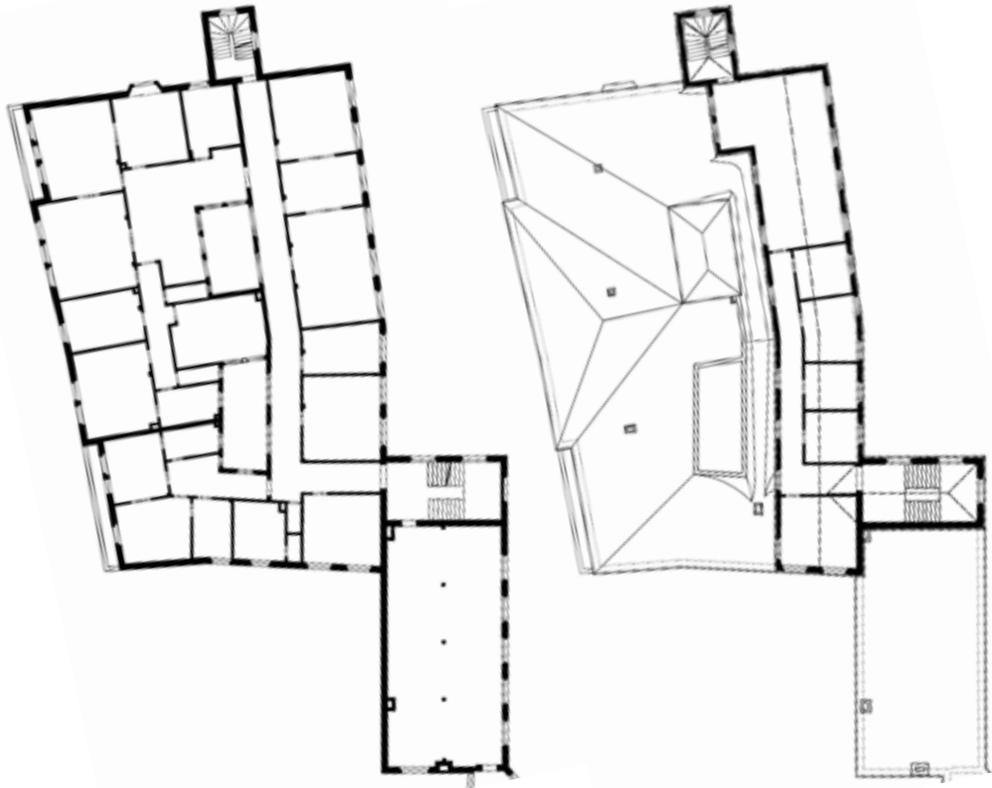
Grundrissdarstellung der Hotelzimmer - Ebene 3, M1:200
